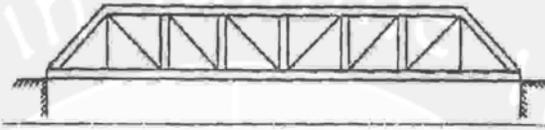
Jembatan Tipe Rangka Kayu (*wooden truss*)
